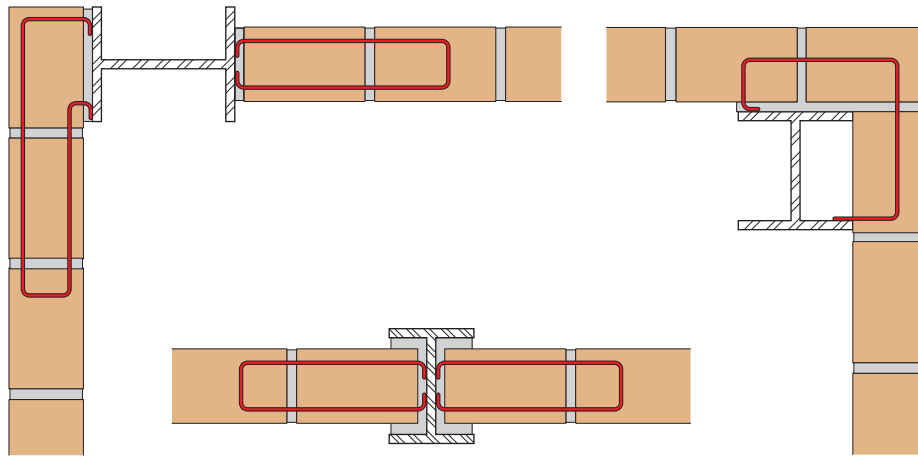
Ligações entre alvenarias e pilares de aço – estrutura aparente.
